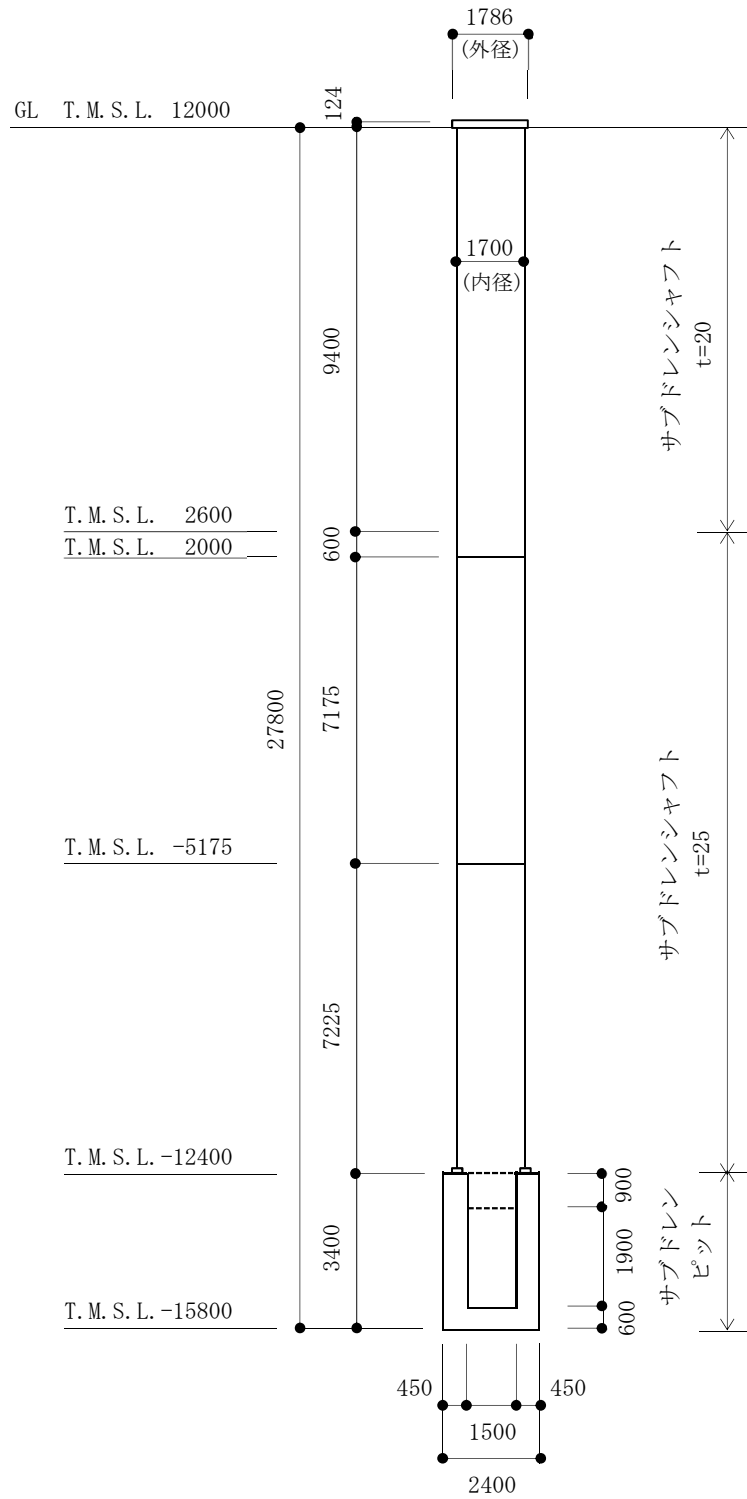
原子炉建屋サブドレンシヤフトの概略断面図 (単位 : mm)
